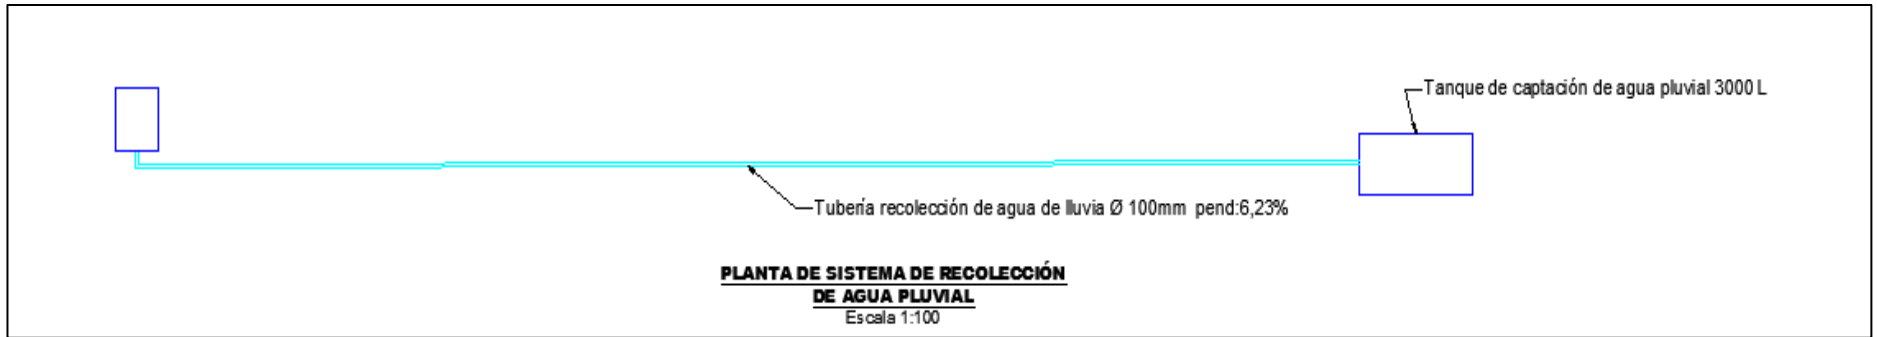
Vista en planta del sistema de recolección de agua pluvial
